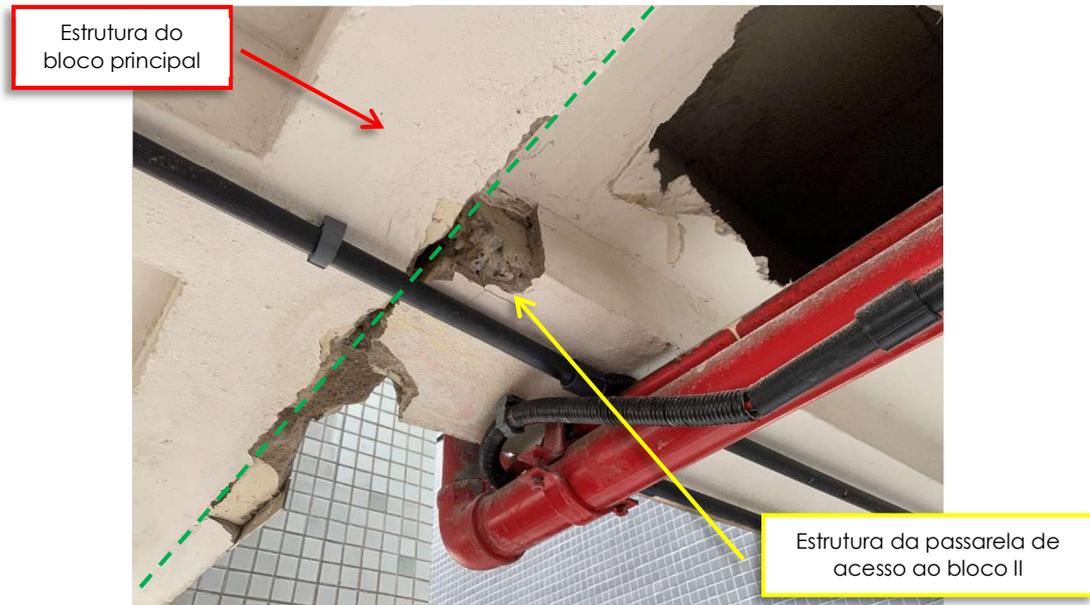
Vista externa do encontro entre as vigas das estruturas próximo a abertura nº 1.
